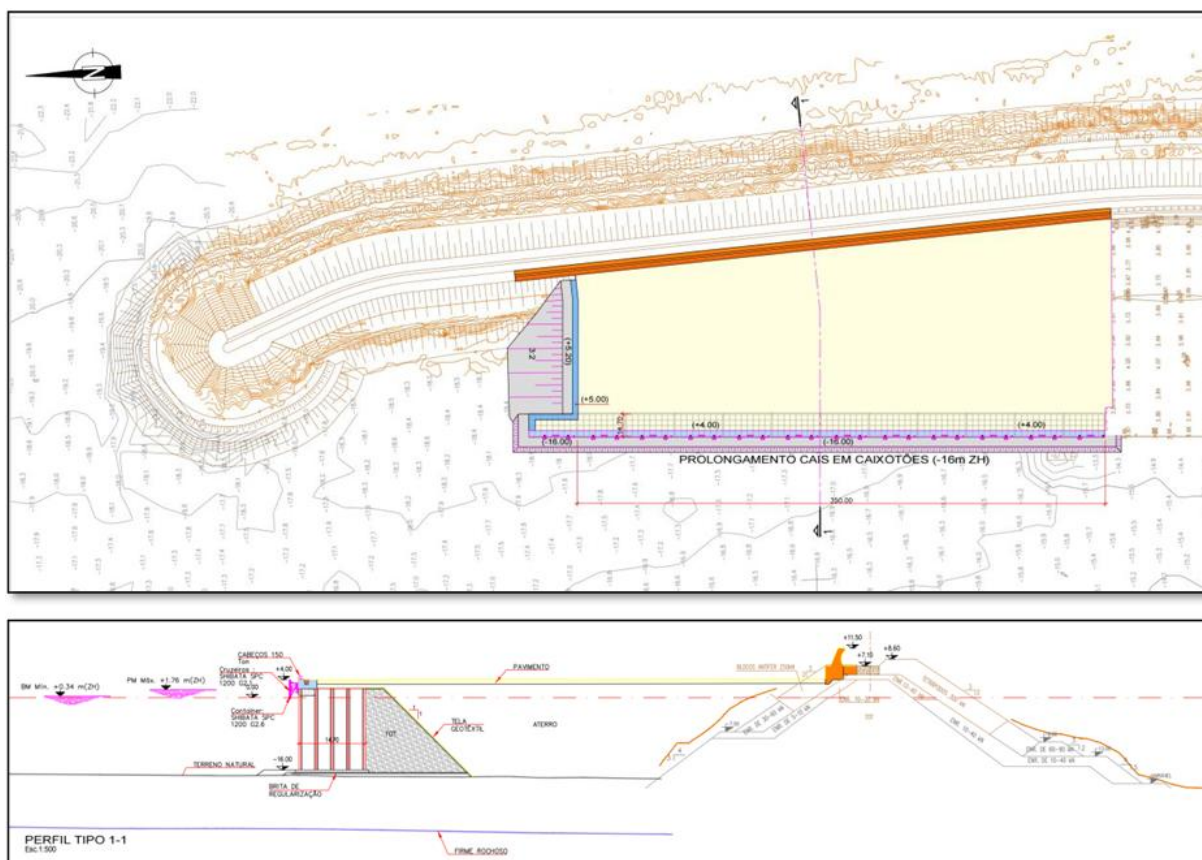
Prolongamento do cais existente à -12m (ZH) – SOLUÇÃO 3B (planta e perfil tipo) (Desenho obtido do Estudo Prévio).
